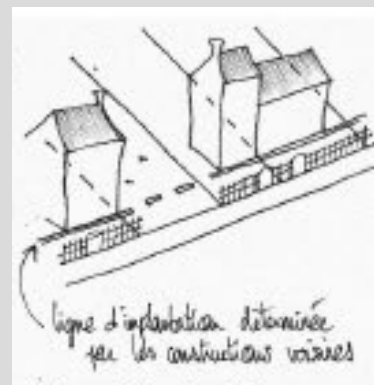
Extrait du PLU de Calan, 2019, p. 16. Ligne d'implantation déterminée par des constructions voisines.
